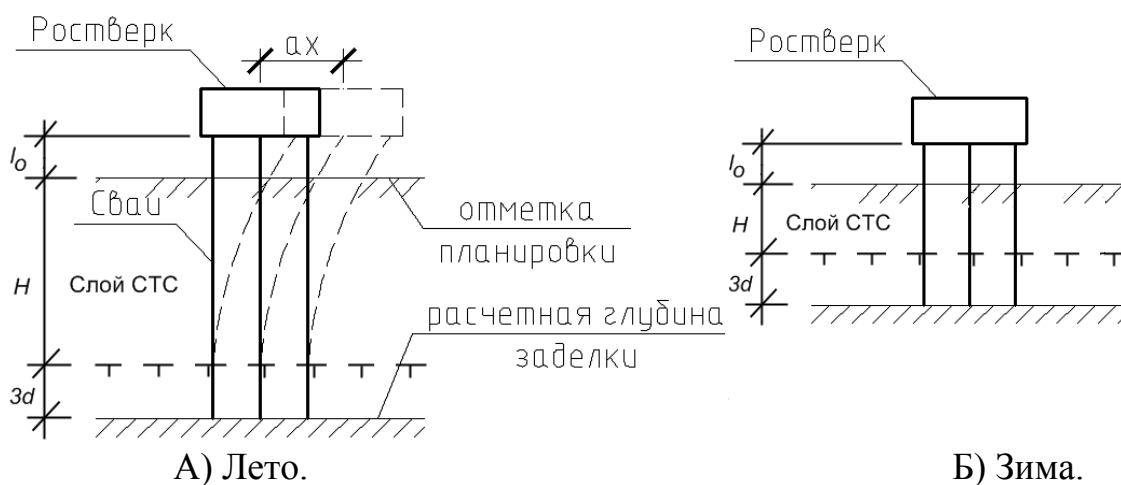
Расчетная глубина условного защемления свайного фундамента в твердомерзлый грунт по [70]
